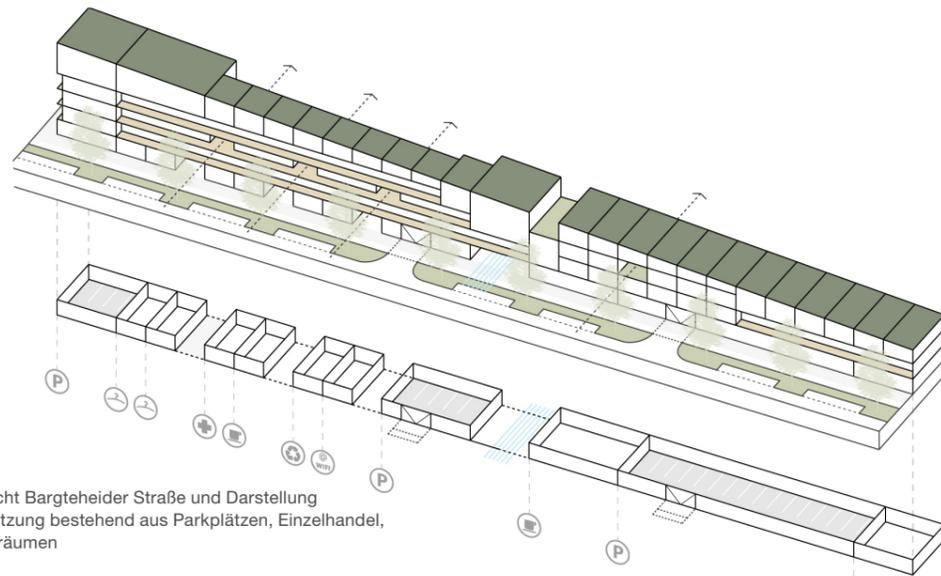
Isometrie: Ansicht Bargtheider Straße und Darstellung Erdgeschossnutzung bestehend aus Parkplätzen, Einzelhandel, Gemeinschaftsräumen
